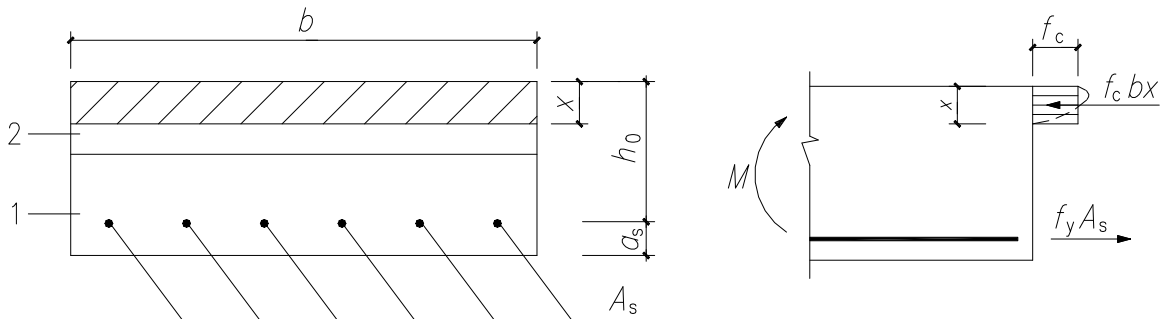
蒸压加气混凝土叠合板正截面承载力计算简图
